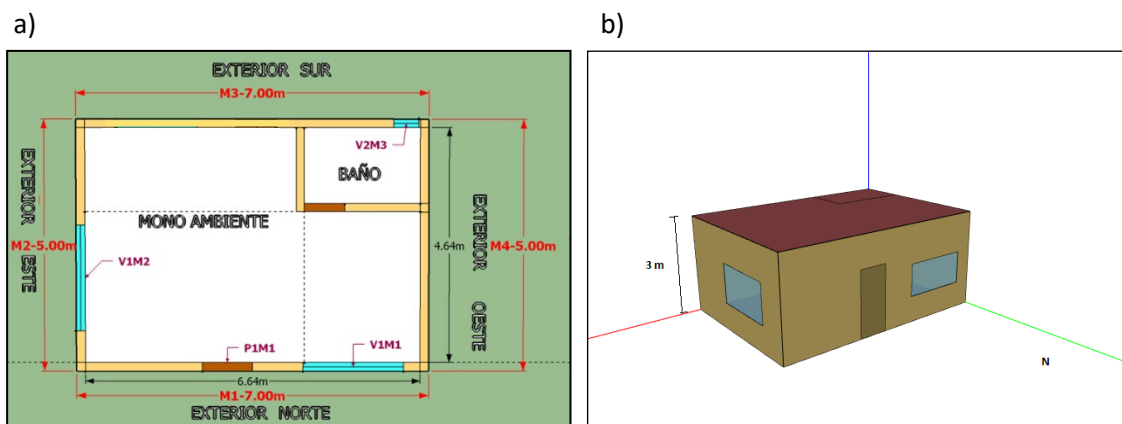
Sistema constructivo estudiado, monoambiente, a) vista en planta y b) vista 3D.
